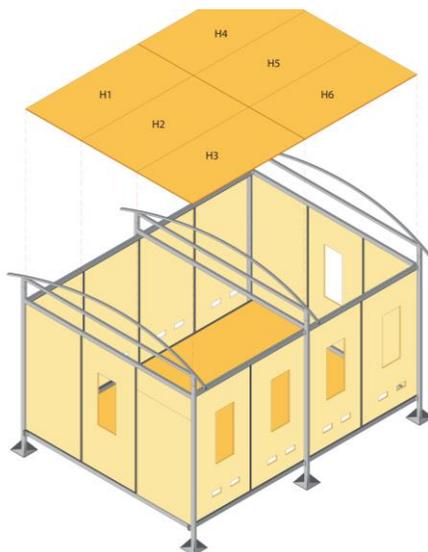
Colocación de tableros OSB para cielo raso de vivienda.
